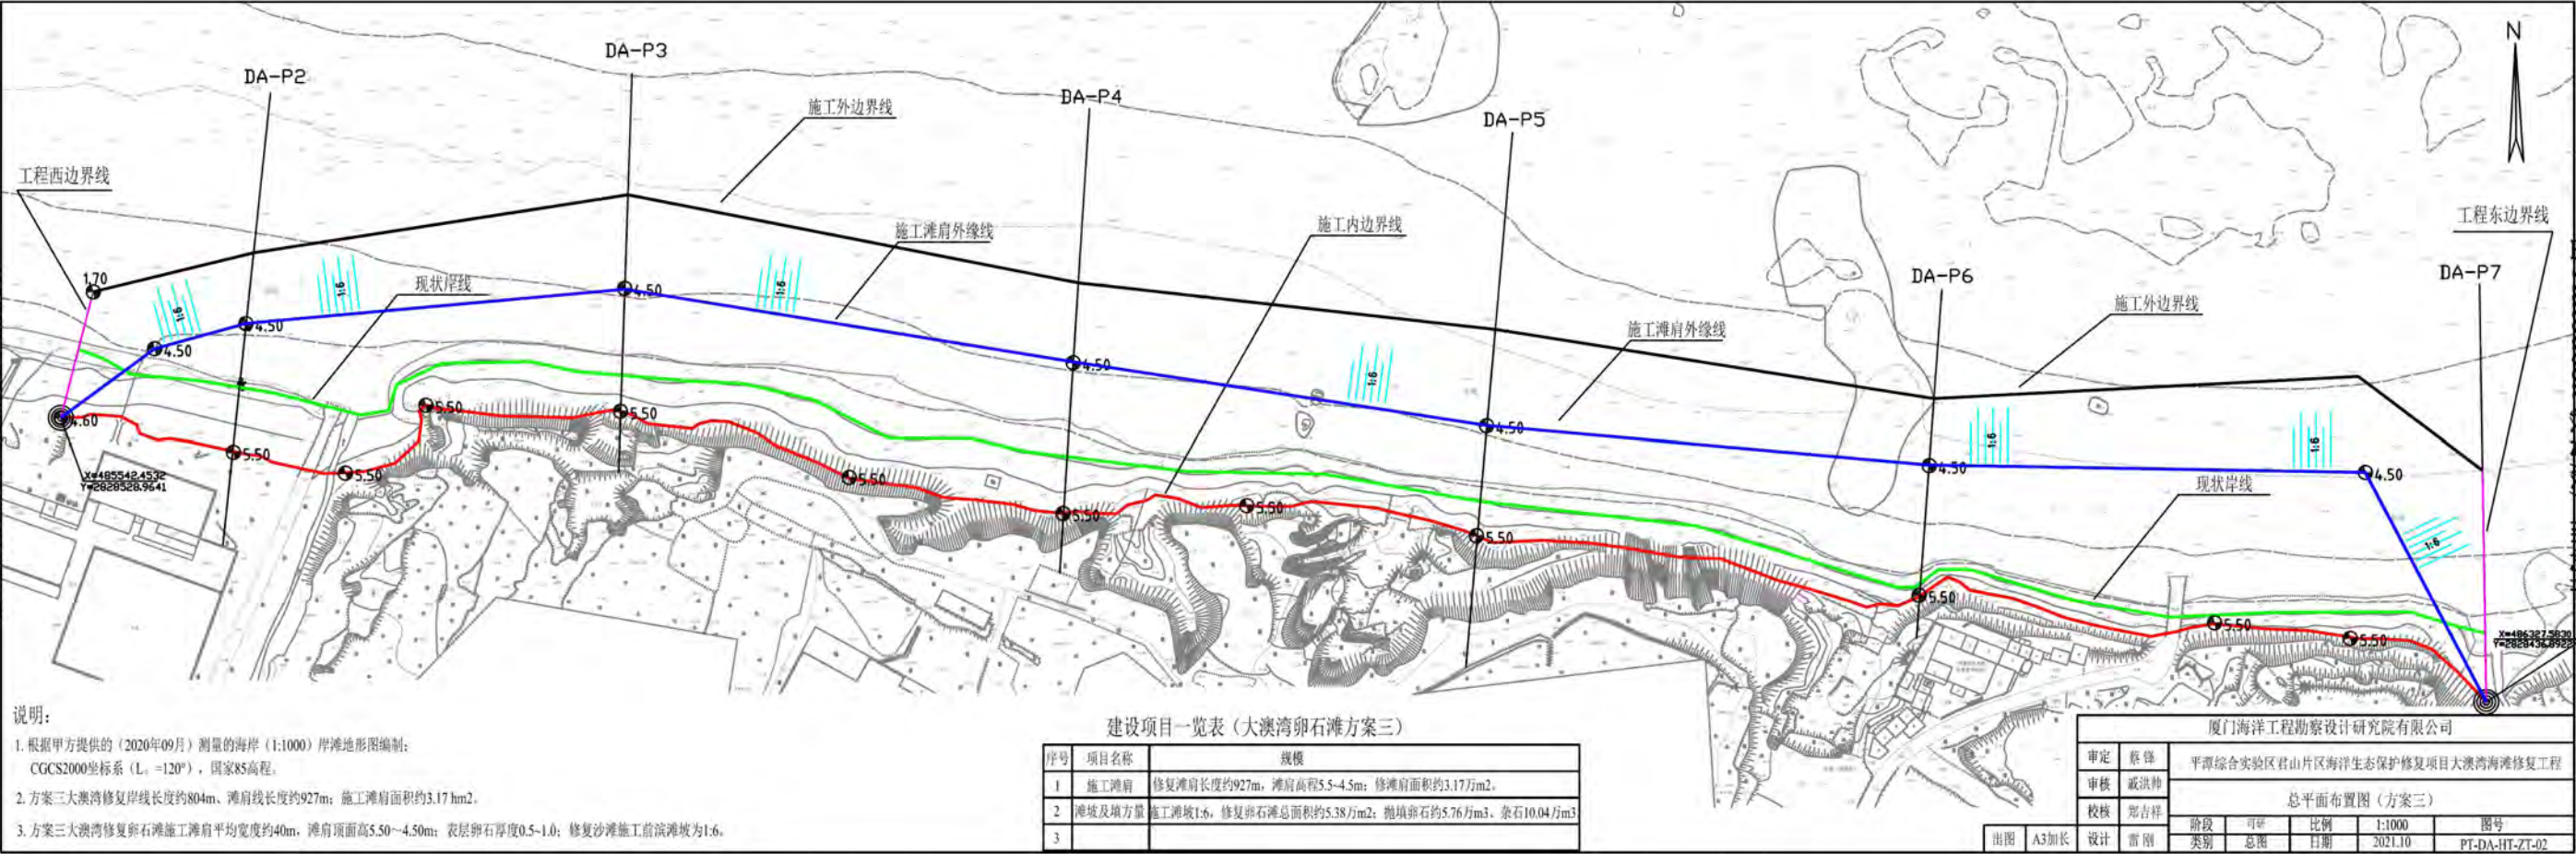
大澳湾卵石海滩工程总平面布置图
